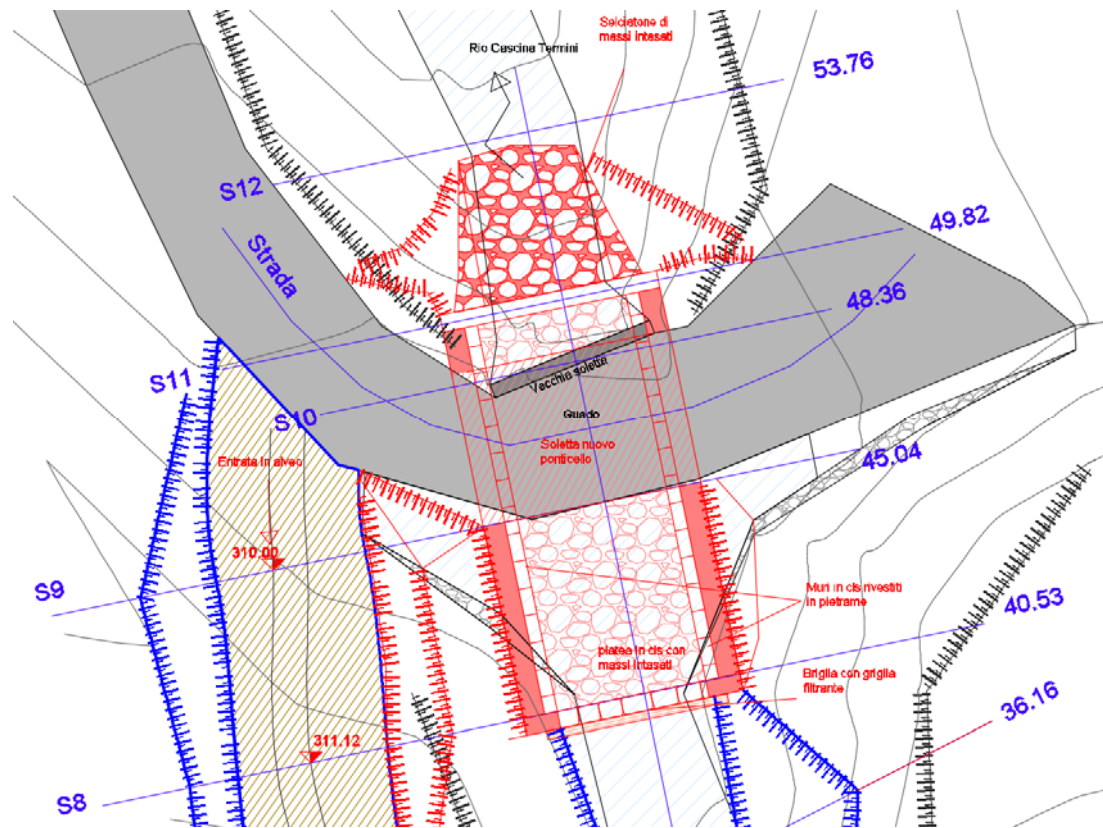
planimetria e sezione di progetto di parte degli interventi nella zona D
